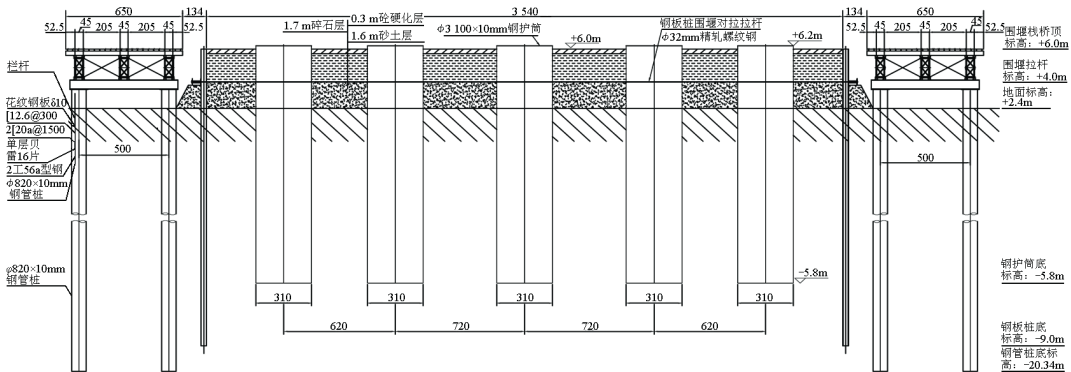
钢板桩围堰钻孔平台及支栈桥立面布置图(单位:cm)
